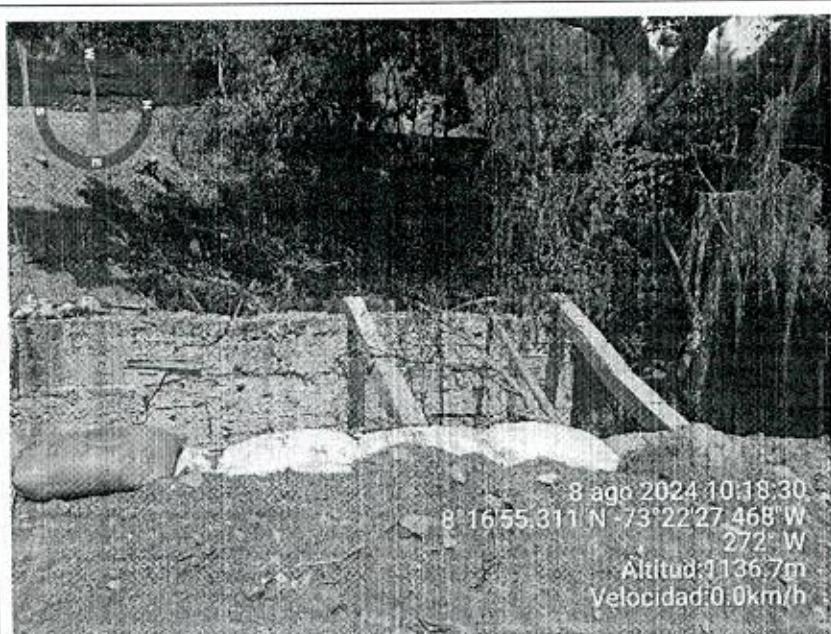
Vista frontal en la construcción de muro de contención en concreto.
